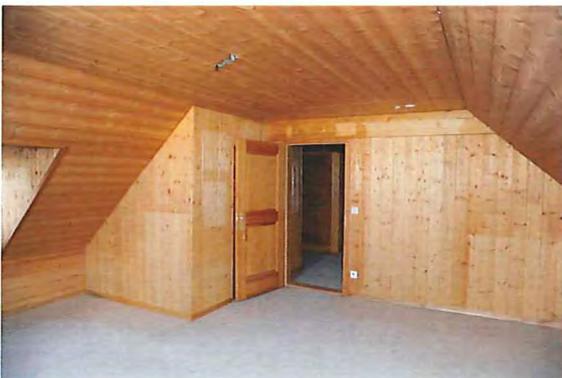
2. Dachgeschoss, Raum 3.04. Blick Richtung Westen mit Tür zu Raum 3.02 (Ausbau 1988).
